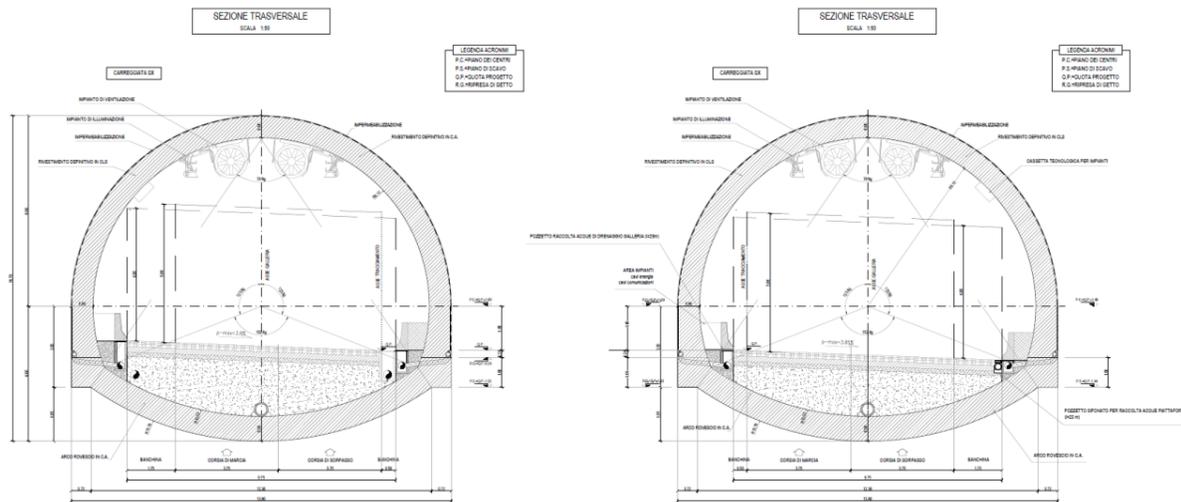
Sezione tipo corrente galleria "Le Ville"
